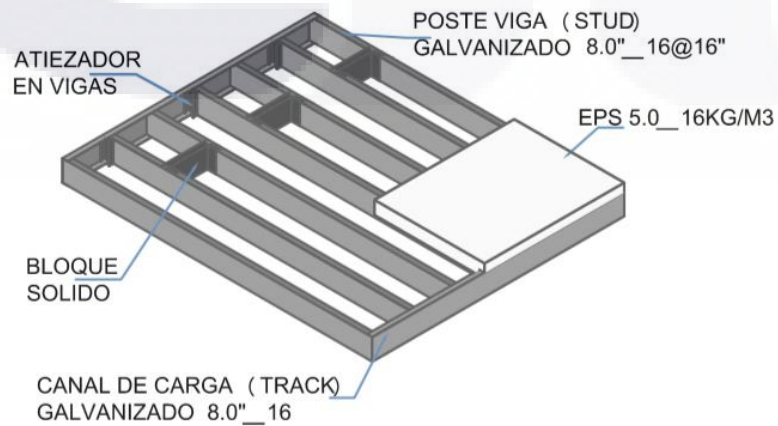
Estructuración típica de panel para losa de azotea (GBS, 2013).
